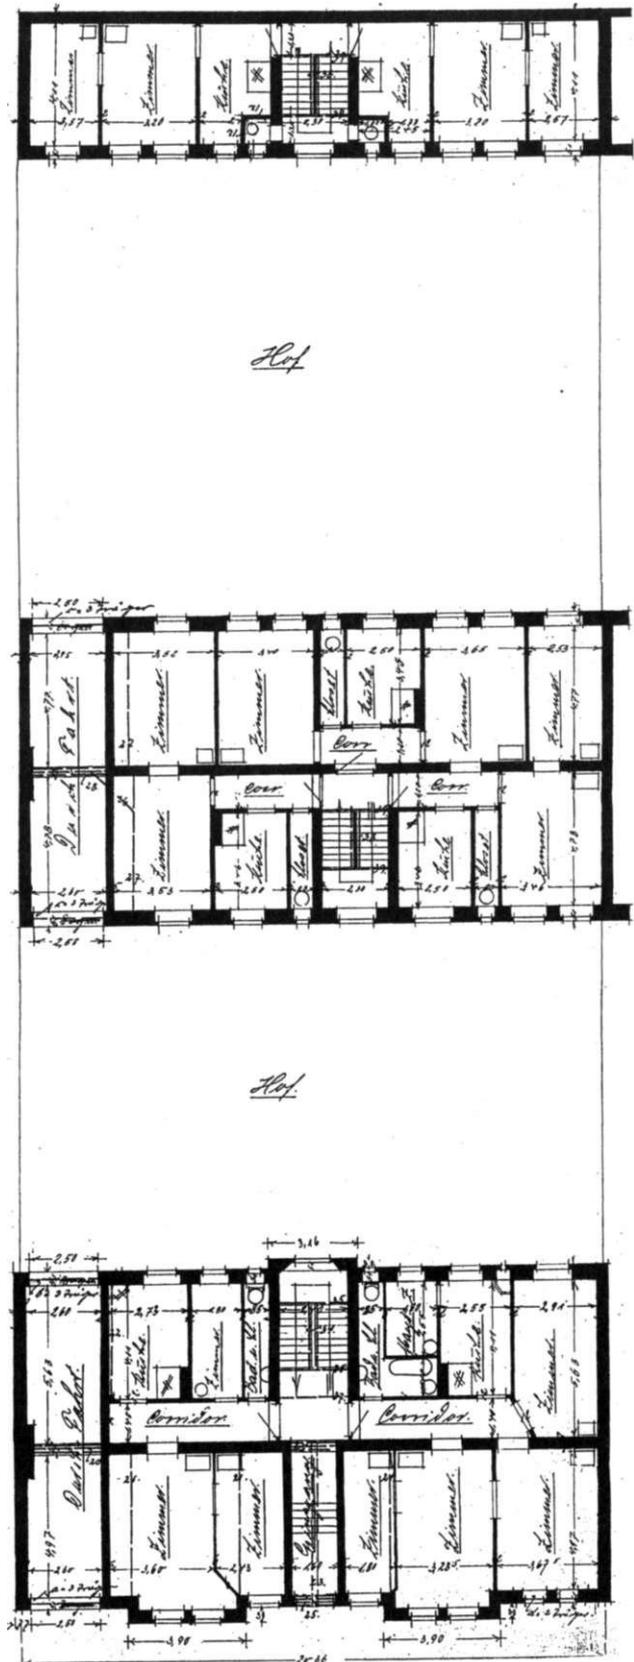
Grundrißtyp B, Liebkechtstraße 48, Erdgeschoß
